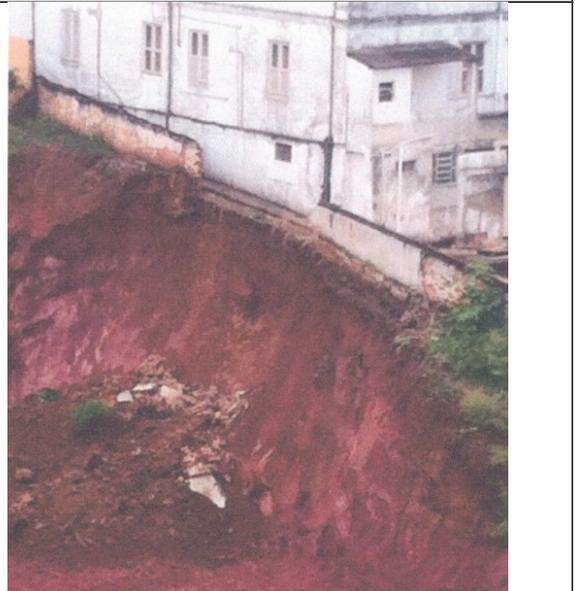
Deslizamento de terra e queda parcial do muro em 19/03/2015.
